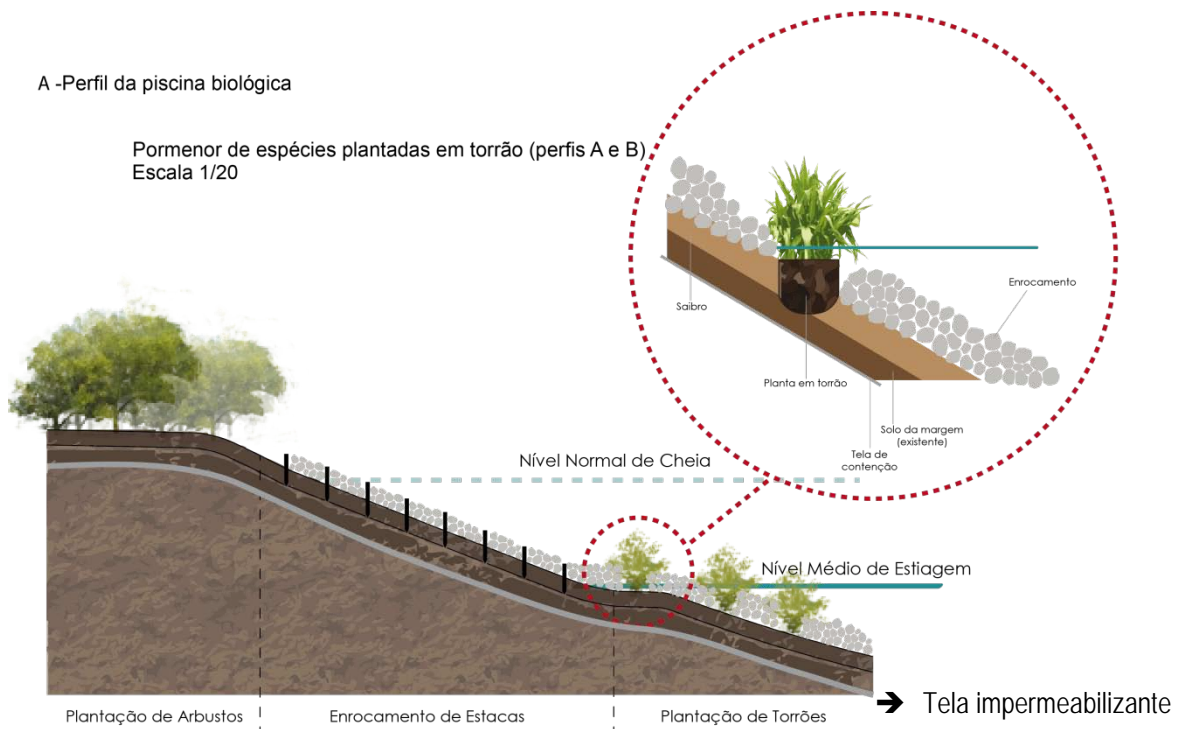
Pormenor construtivo das técnicas de estabilização da piscina biológica
